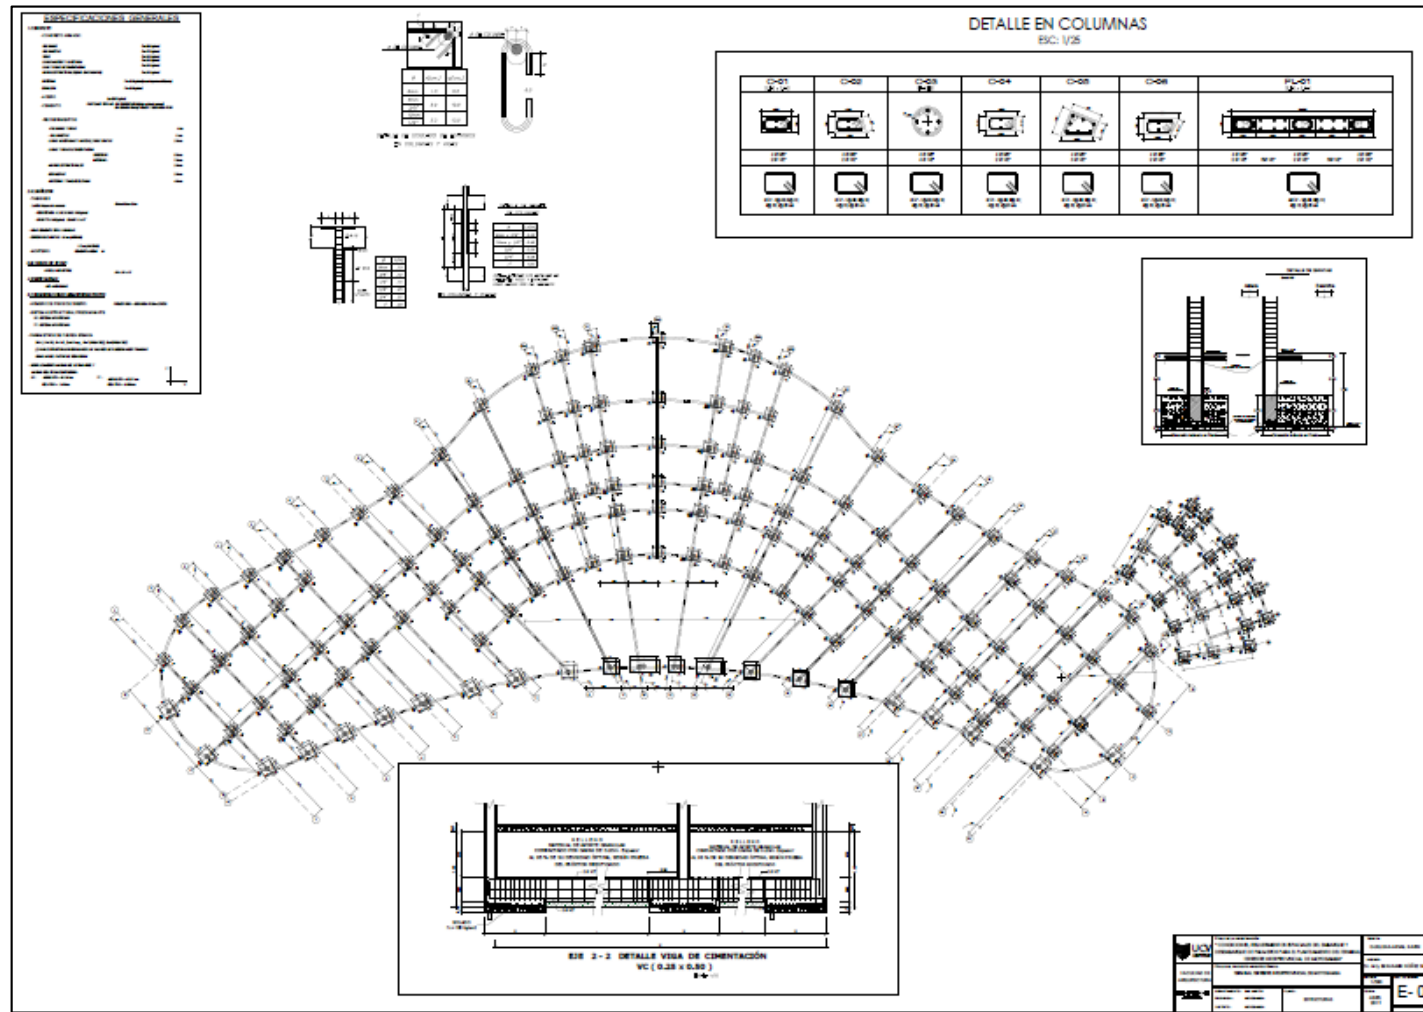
Plano diseño estructural, Fuente: Elaboración propia.
